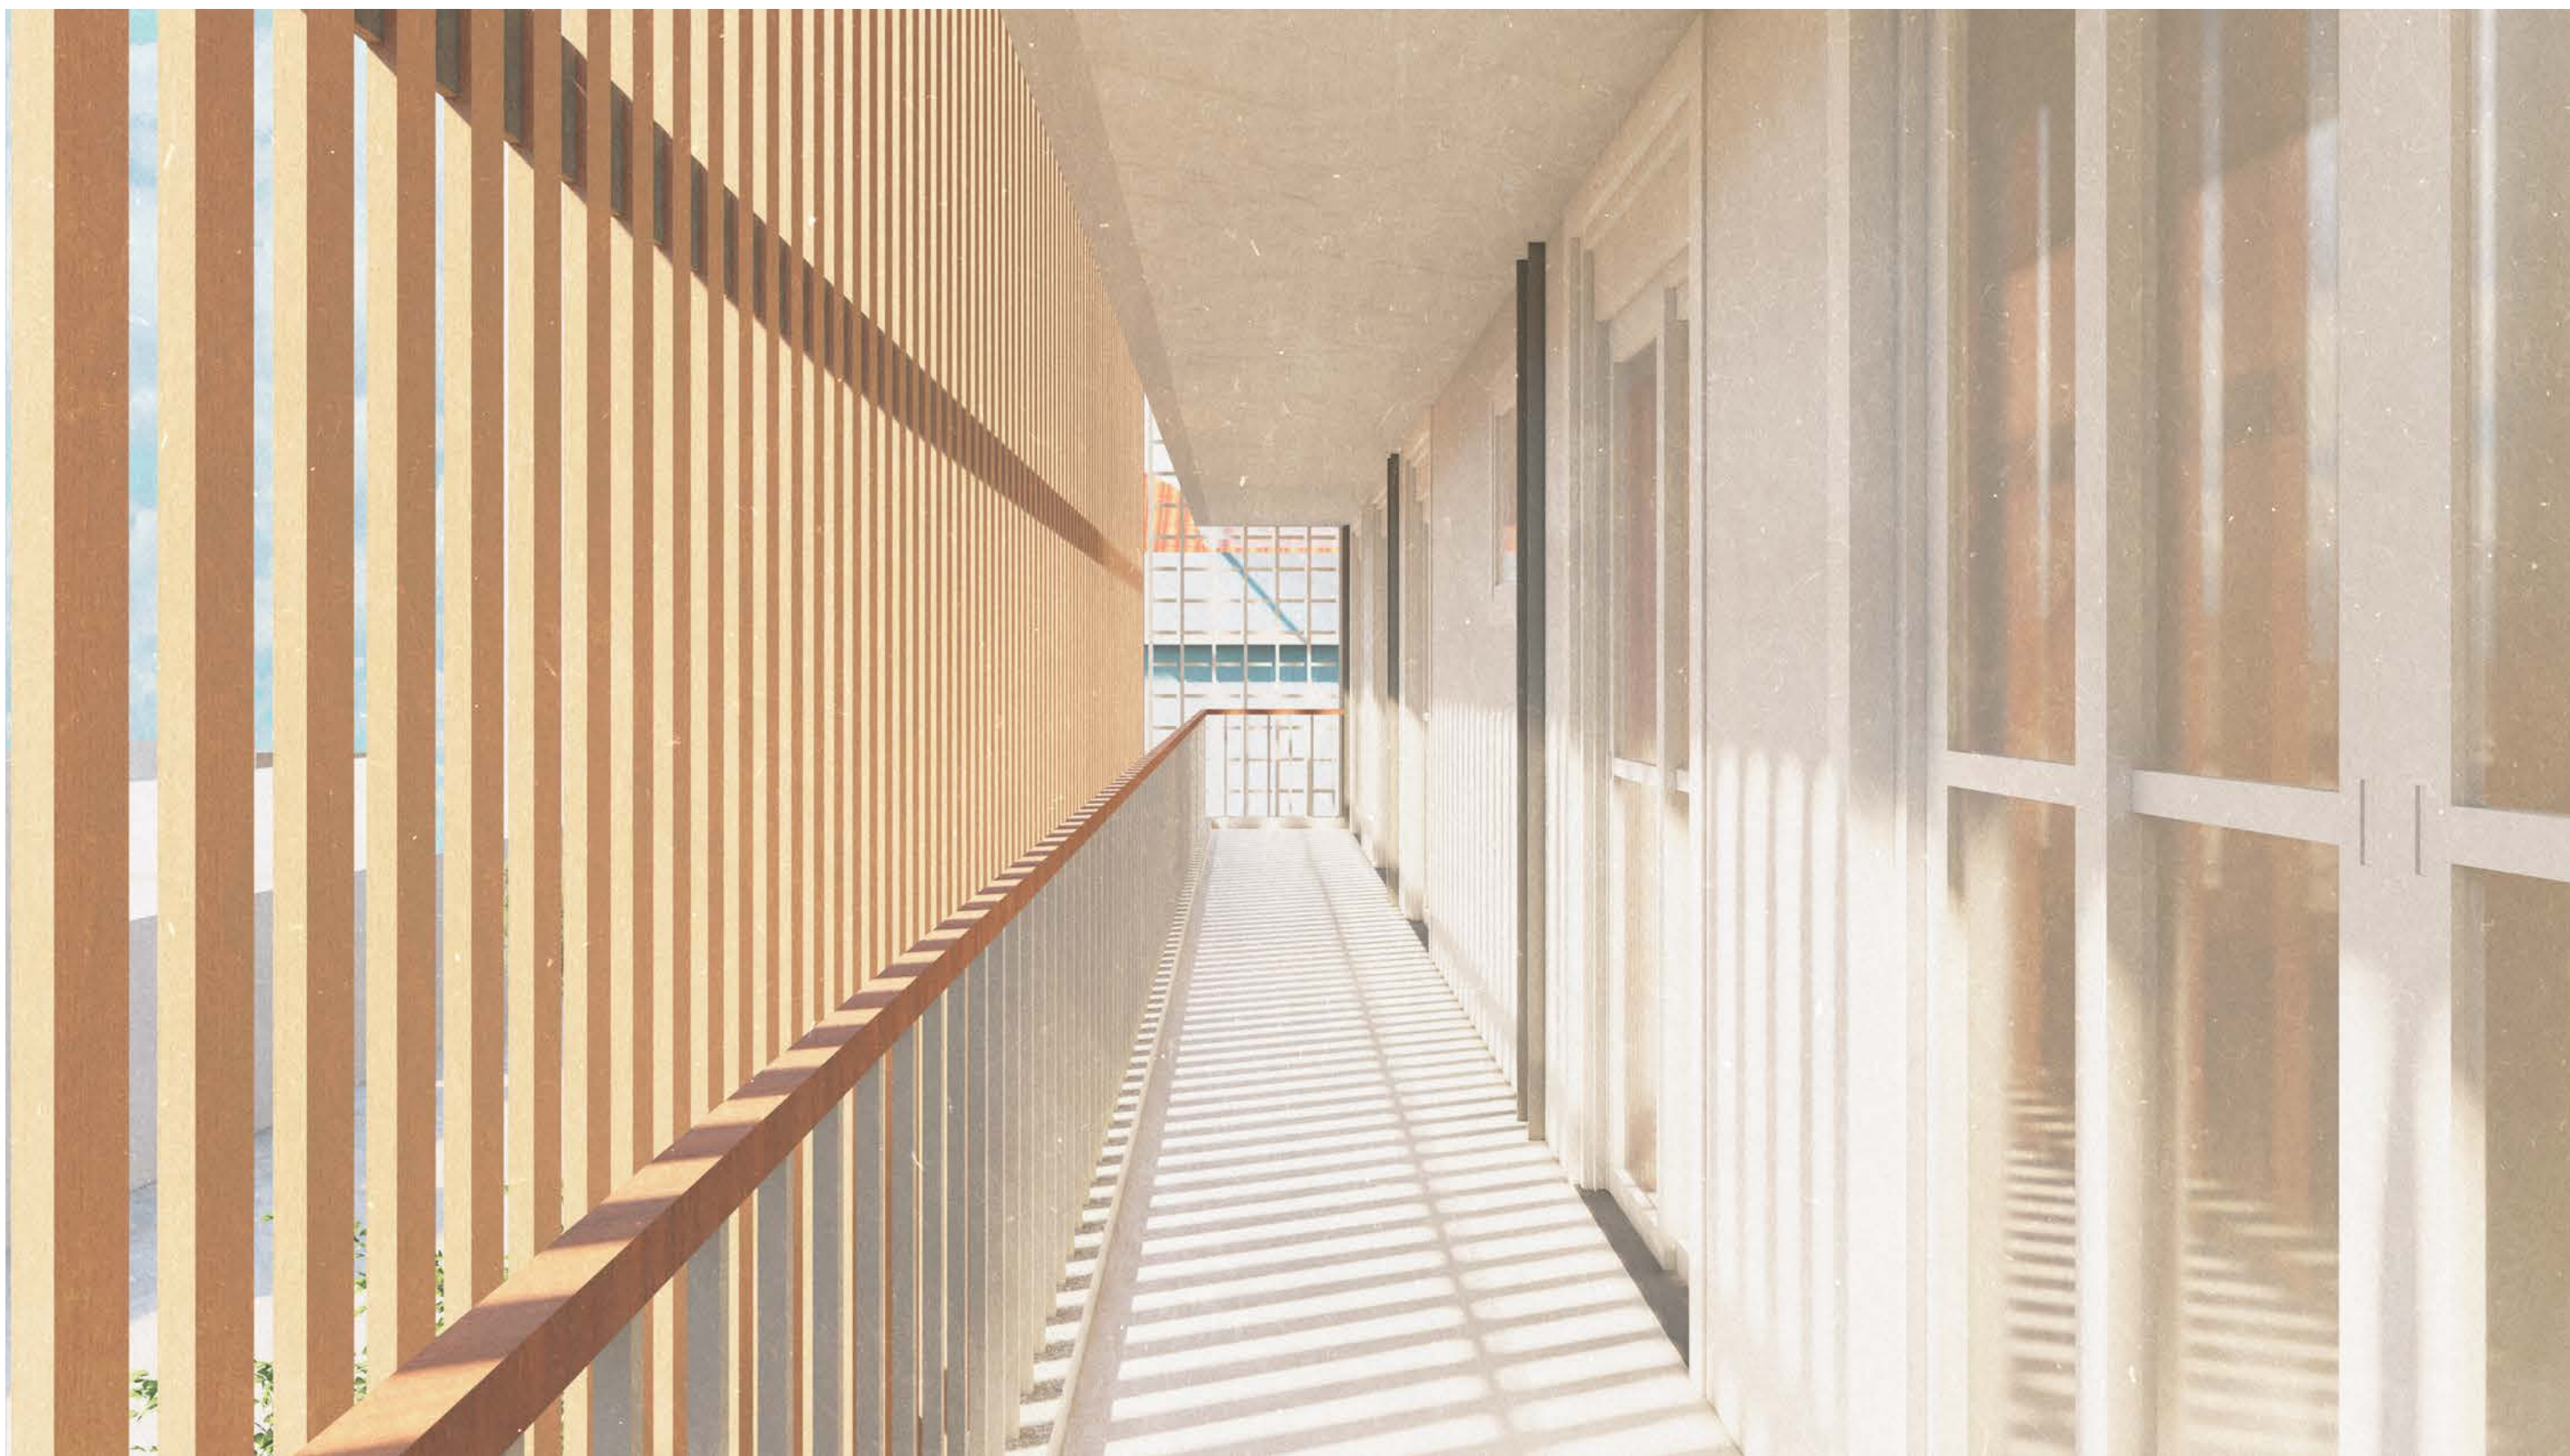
Vista da varanda dos dormitórios na fachada da caixa..
